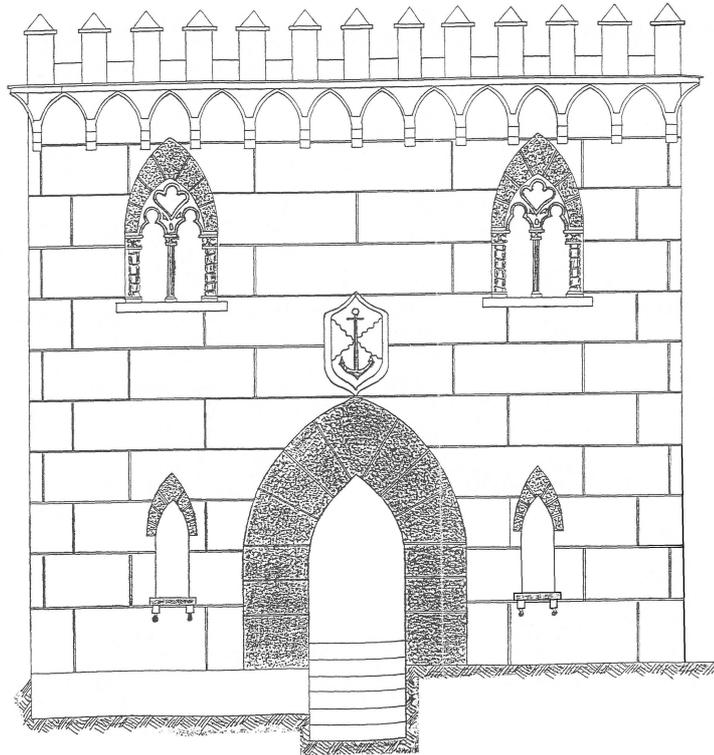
Fachada principal de Santa Catalina. (Plano de la AMM)
